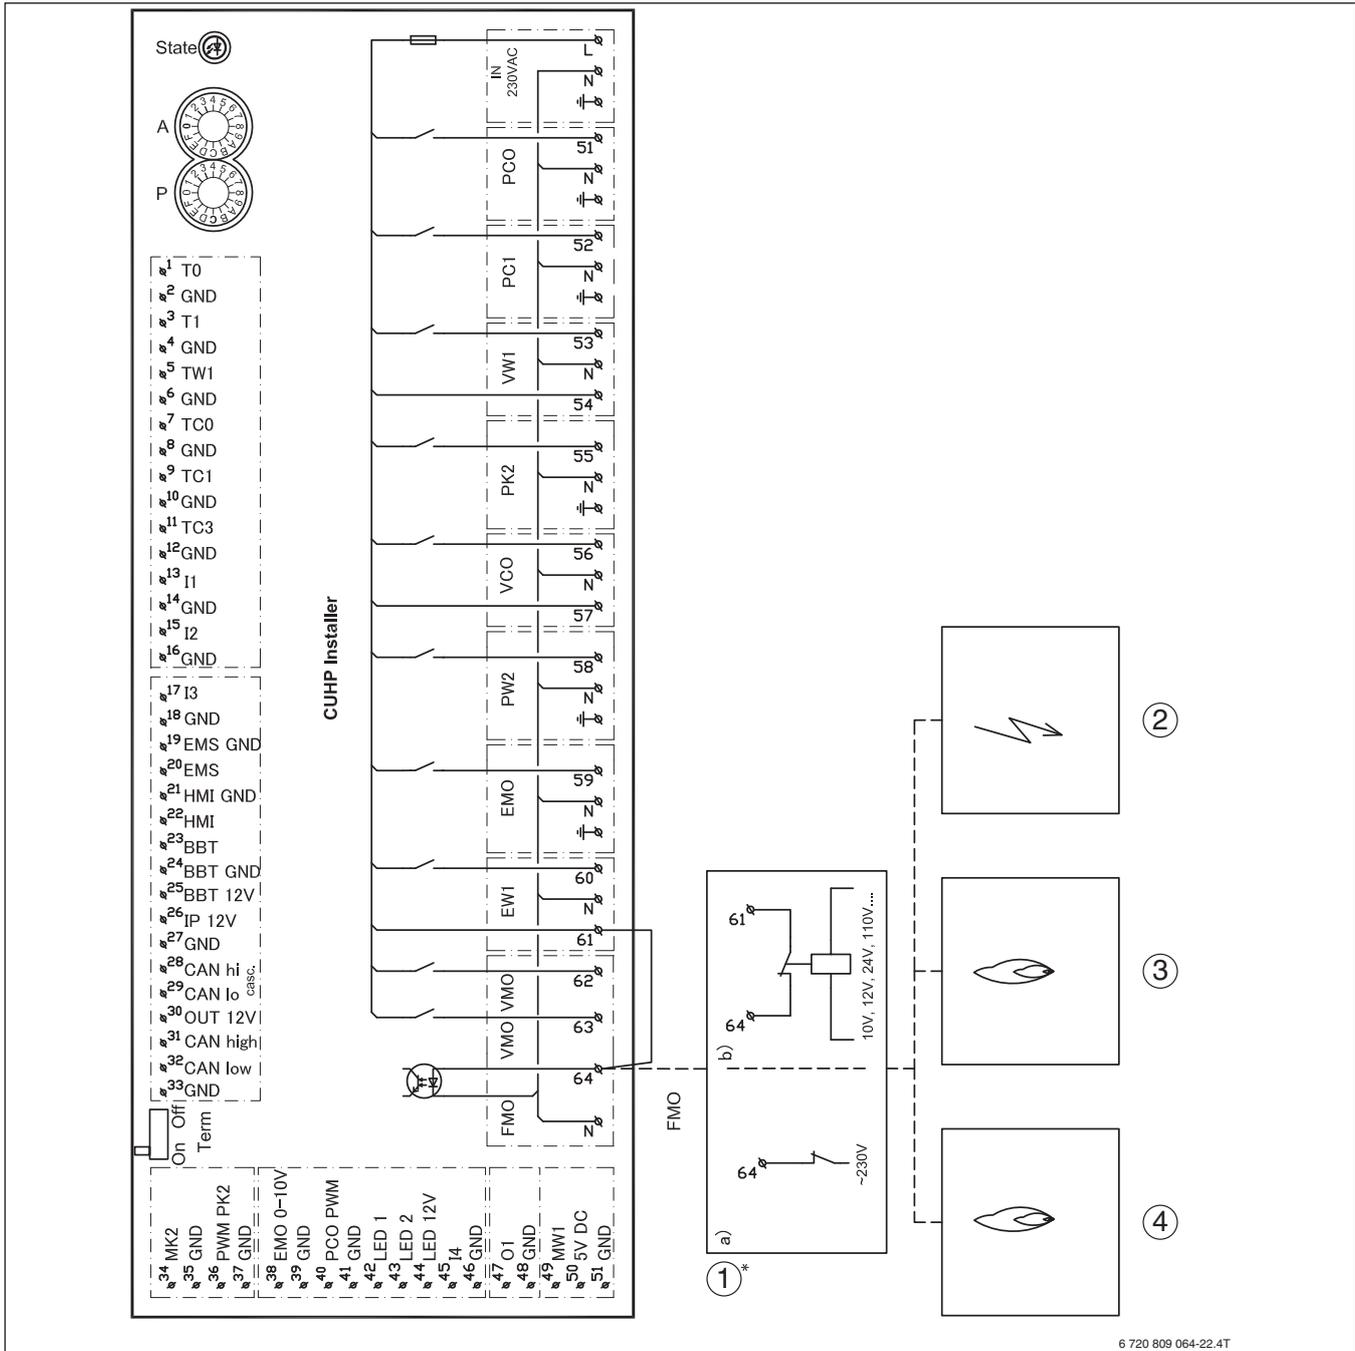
Schaltplan Installationsmodul, Alarm des externen Zuheizers
